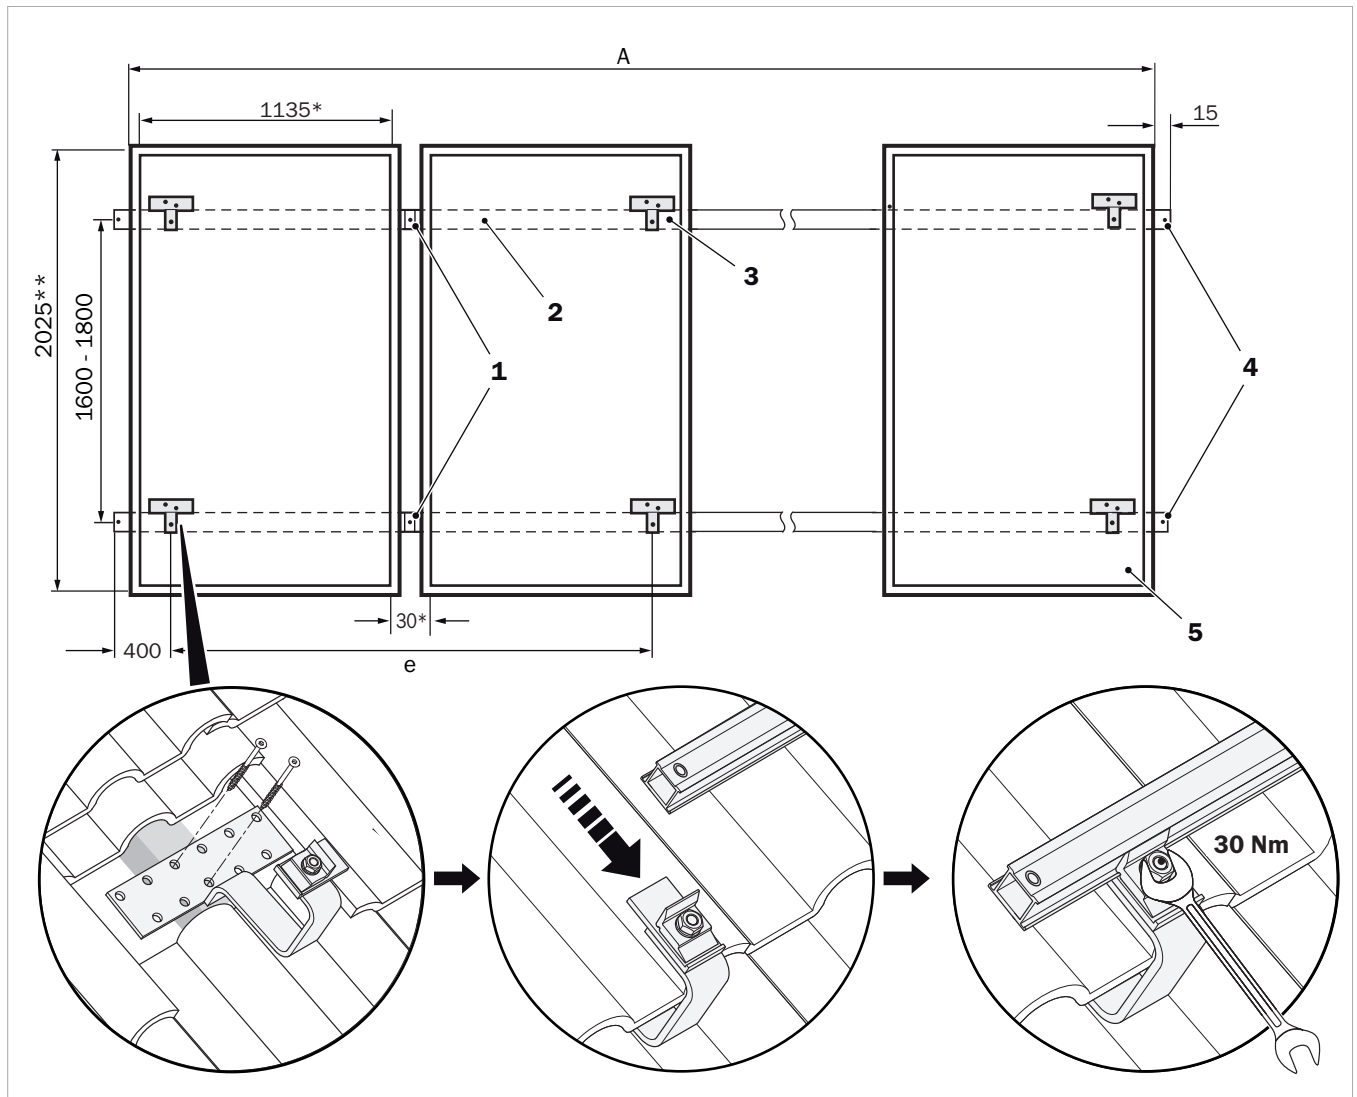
Nebeneinandermontage der Dachhalter und Montageschienen.
